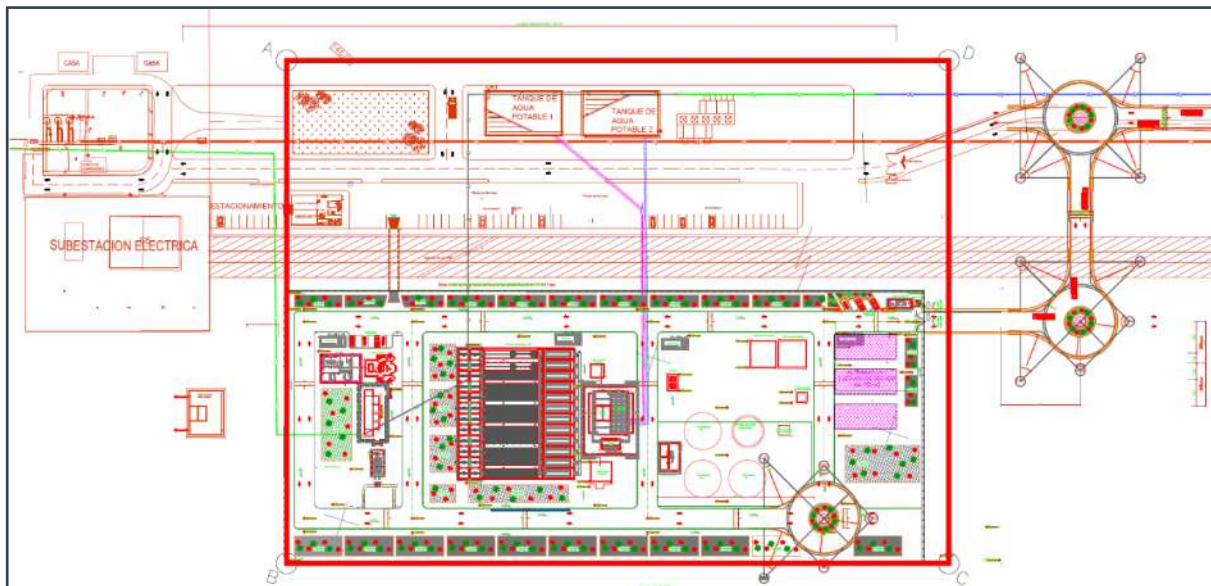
Arreglo general en planta de instalaciones de la planta potabilizadora
